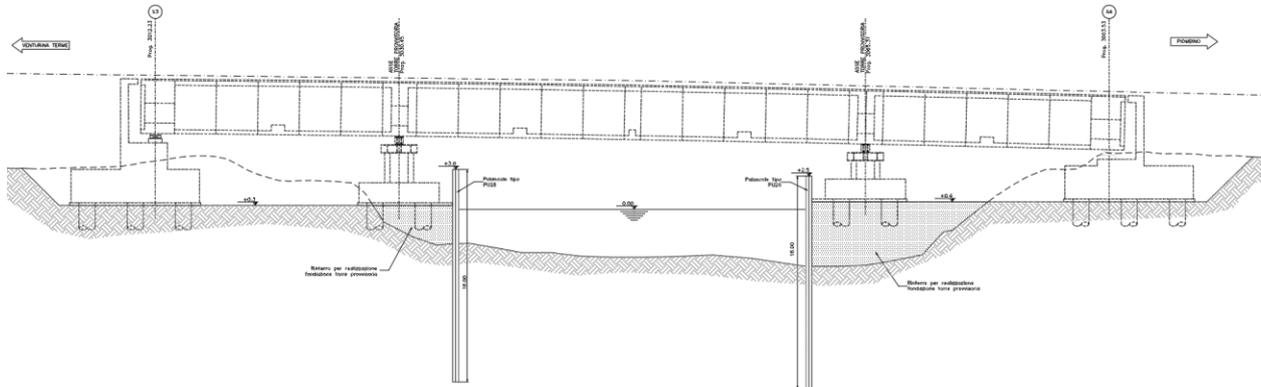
Vista in sezione delle palancole provvisorie previste per il Viadotto V02 (asse destro).
